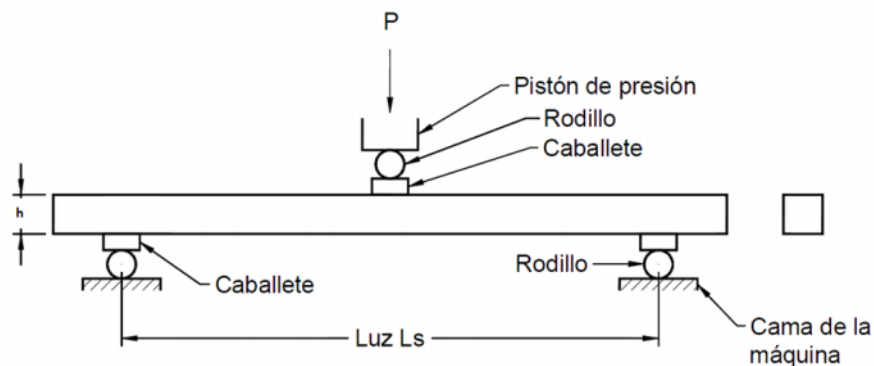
Montaje de prueba de corte longitudinal por flexión
